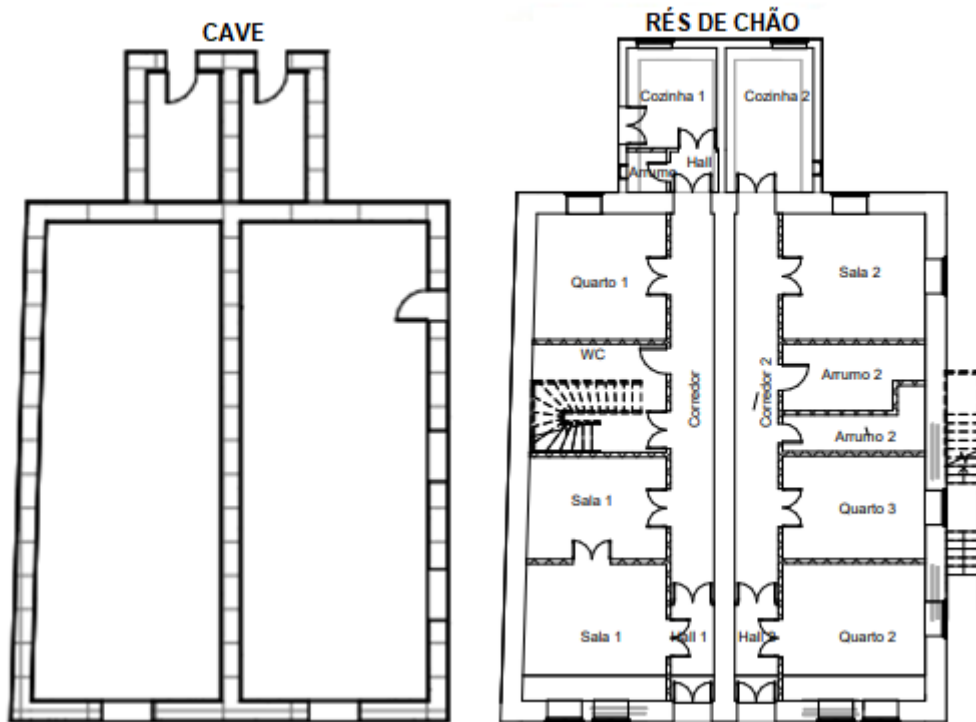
Planta baixa do desvão sanitário e Rés de chão (sem escala)
